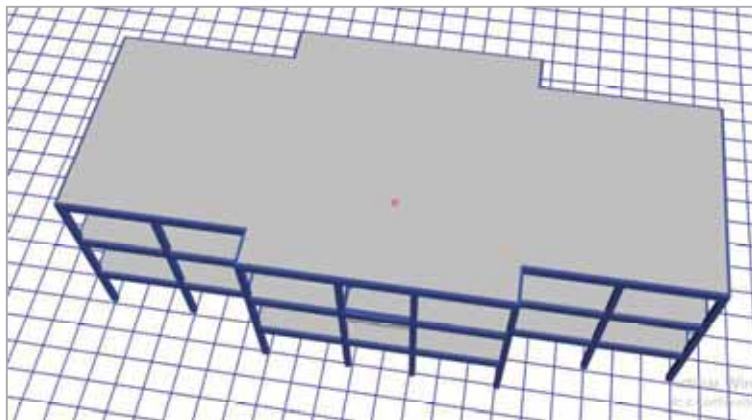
Modelo matemático A considerando solo pórticos de concreto armado.
